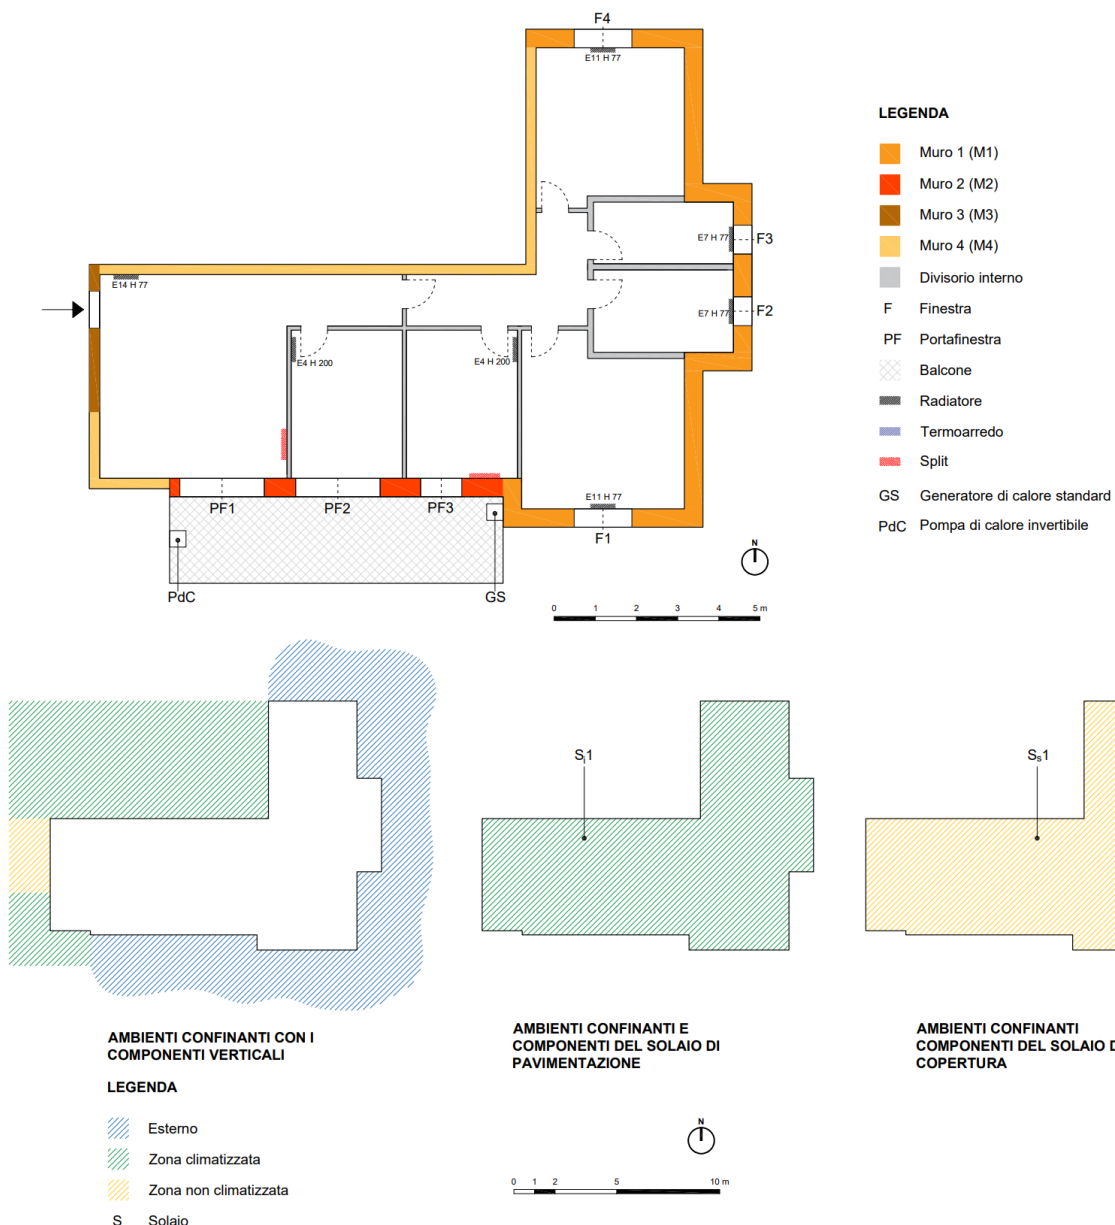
Caratterizzazione geometrica e individuazione delle zone confinanti.
